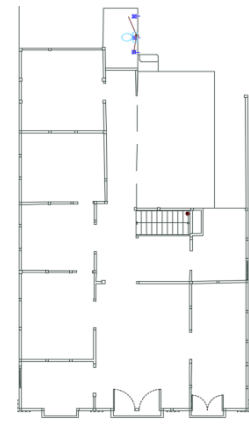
Plano de planta alta de la Casa Viteri. (INPC, 2017)
